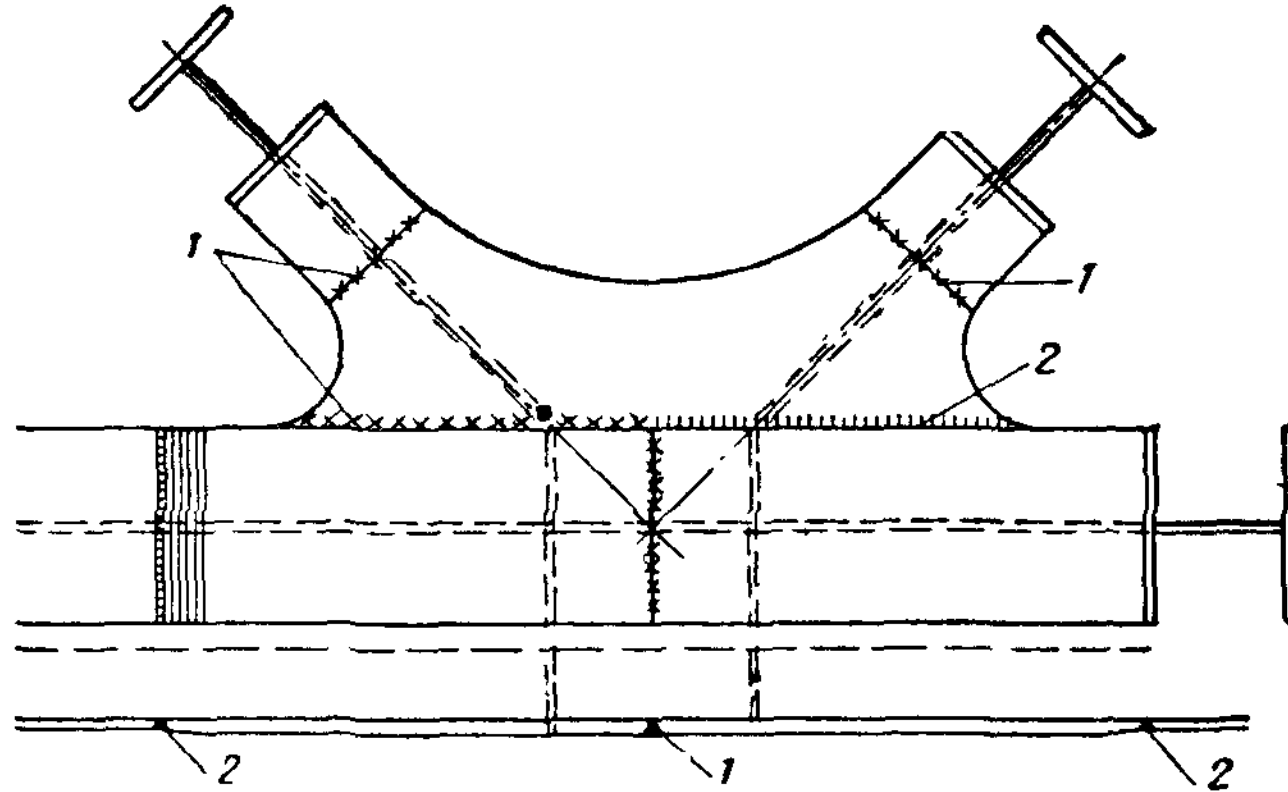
Узел сварной фермы со стыком пояса в центре узла
